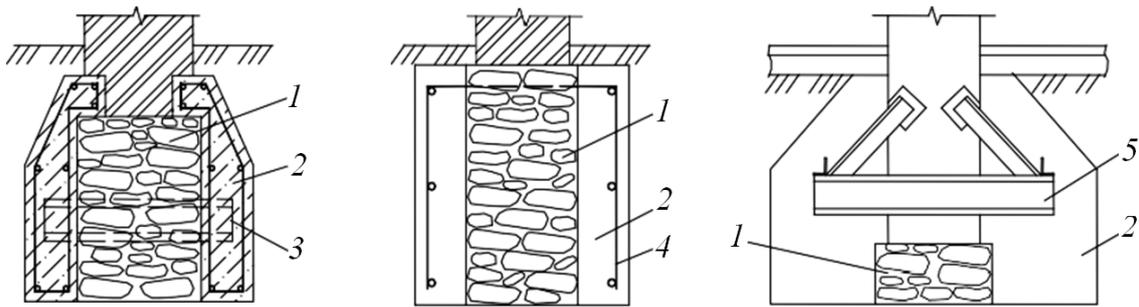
Варианты усиления бутовых фундаментов обоймами: а – с креплением их балками и штрабами; б – арматурными элементами; в – жестким металлическим каркасом; 1 – существующий фундамент; 2 – обойма усиления; 3 – металлическая балка; 4 – арматурные стержни; 5 – металлический каркас
